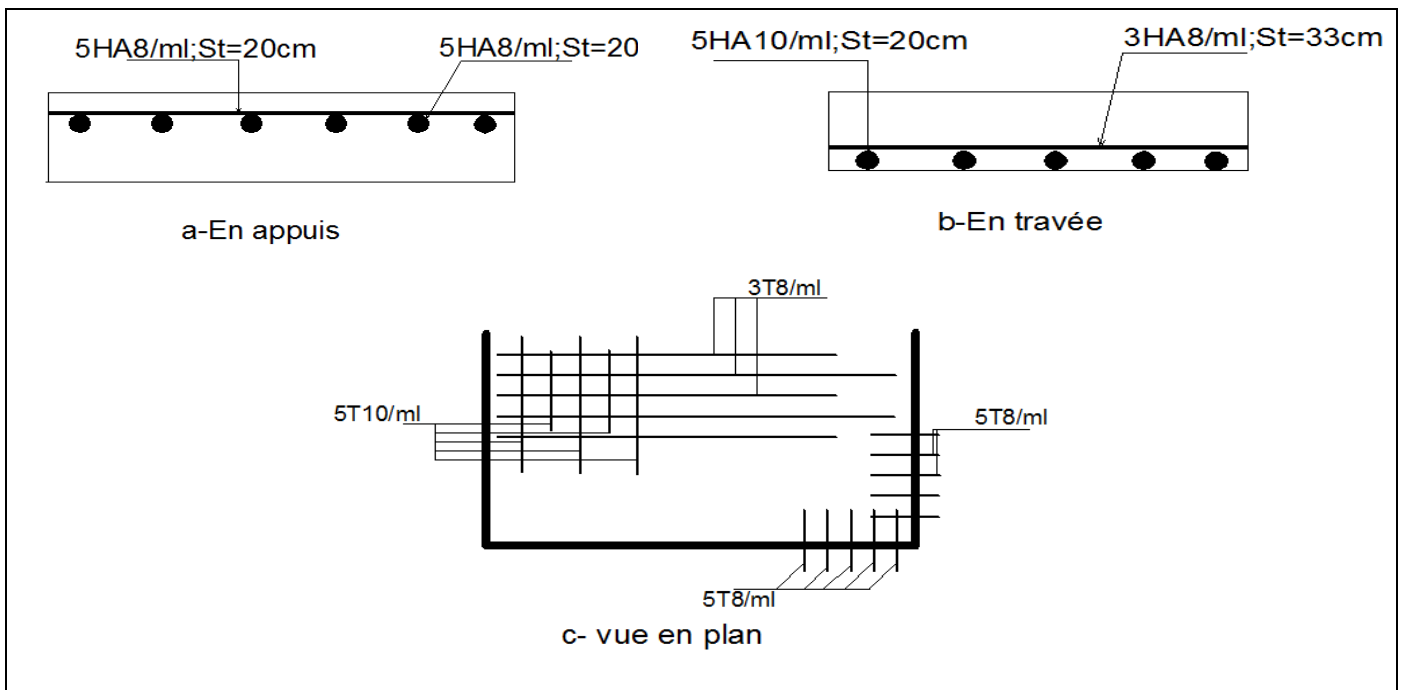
Schéma de ferrailage de la dalle sur trois appuis.
